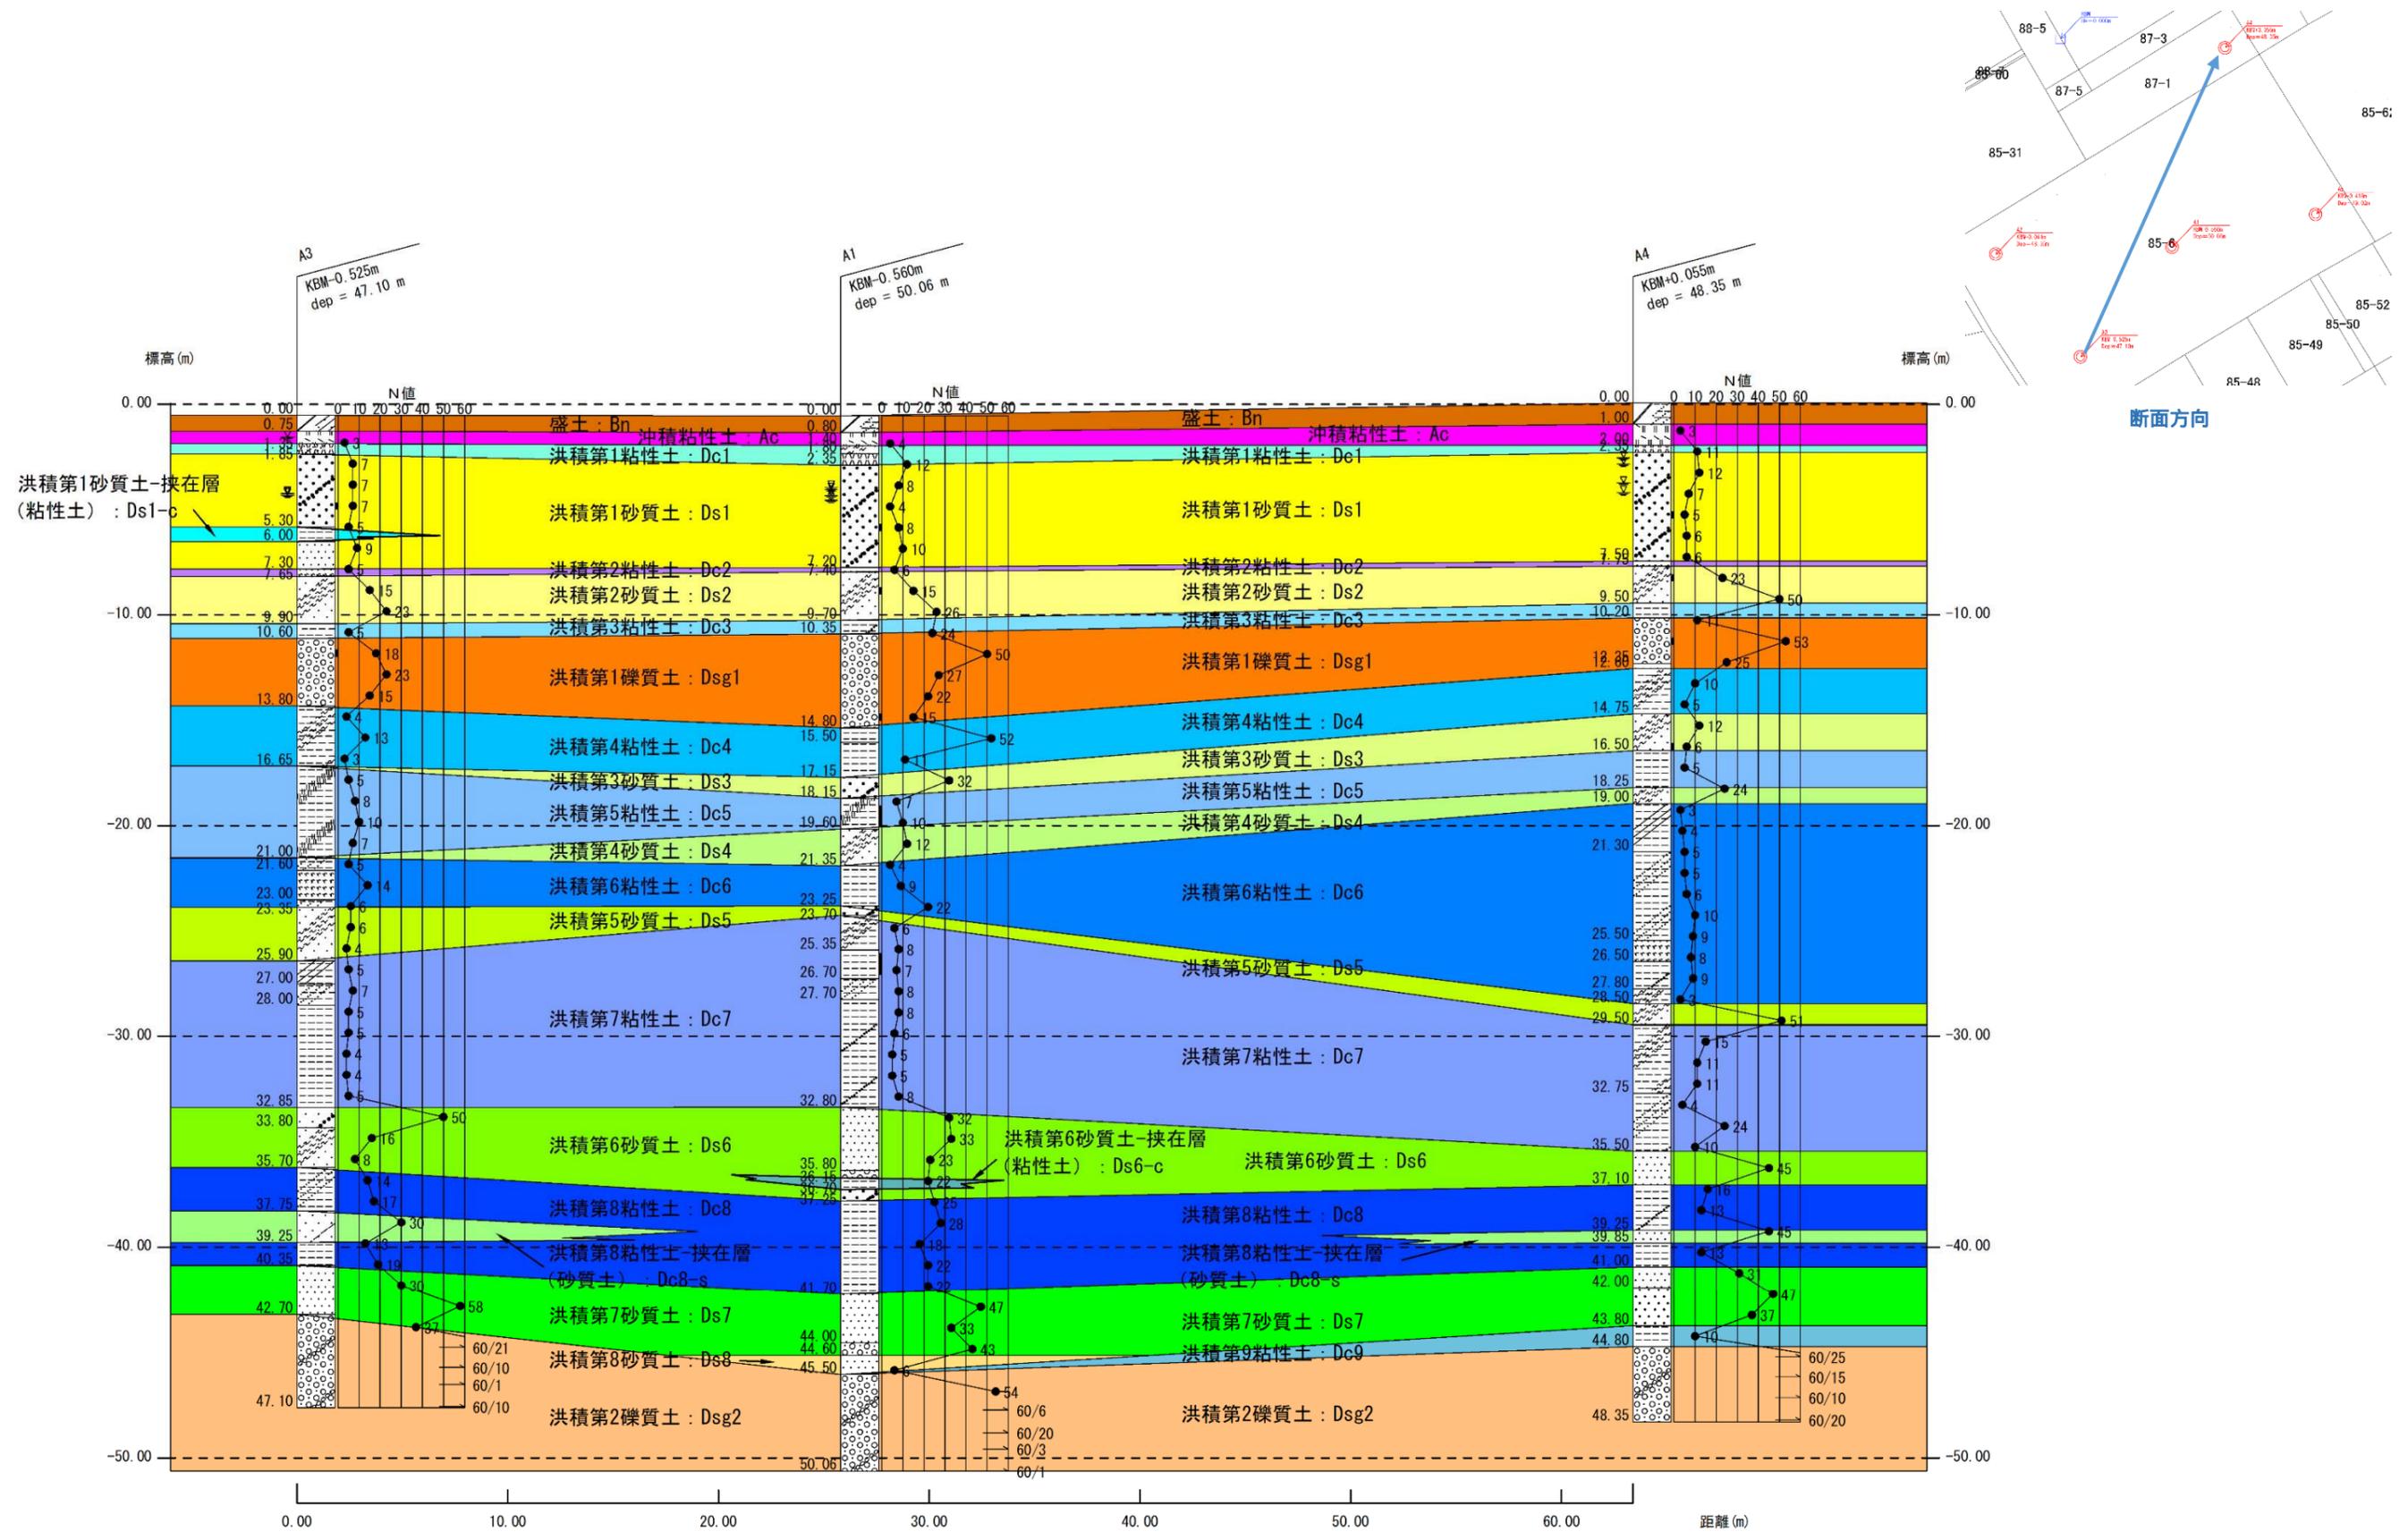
推定地層断面图 A3-A1-A4 (S=1/300)
